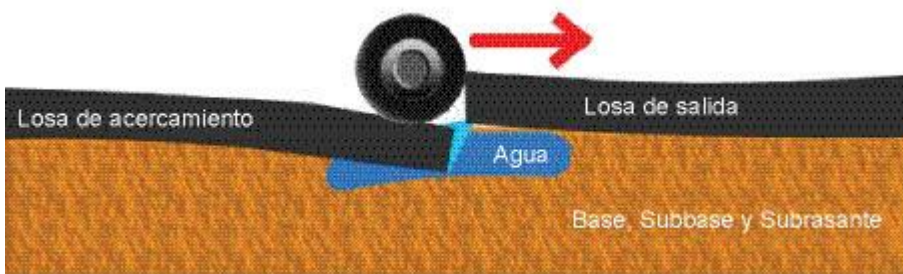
b.6 Bombeo el pavimentos rígidos.
